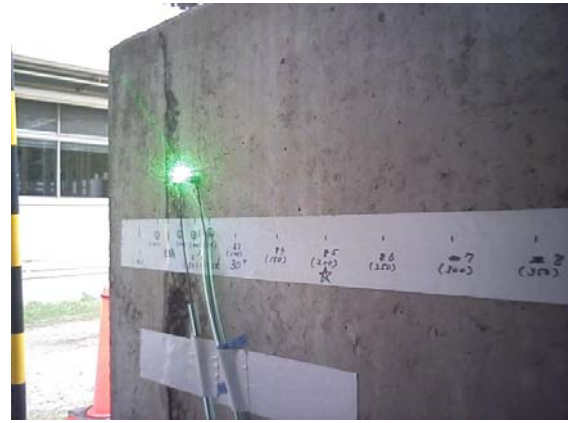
コンクリート欠陥供試体へのレーザーの照射状況
